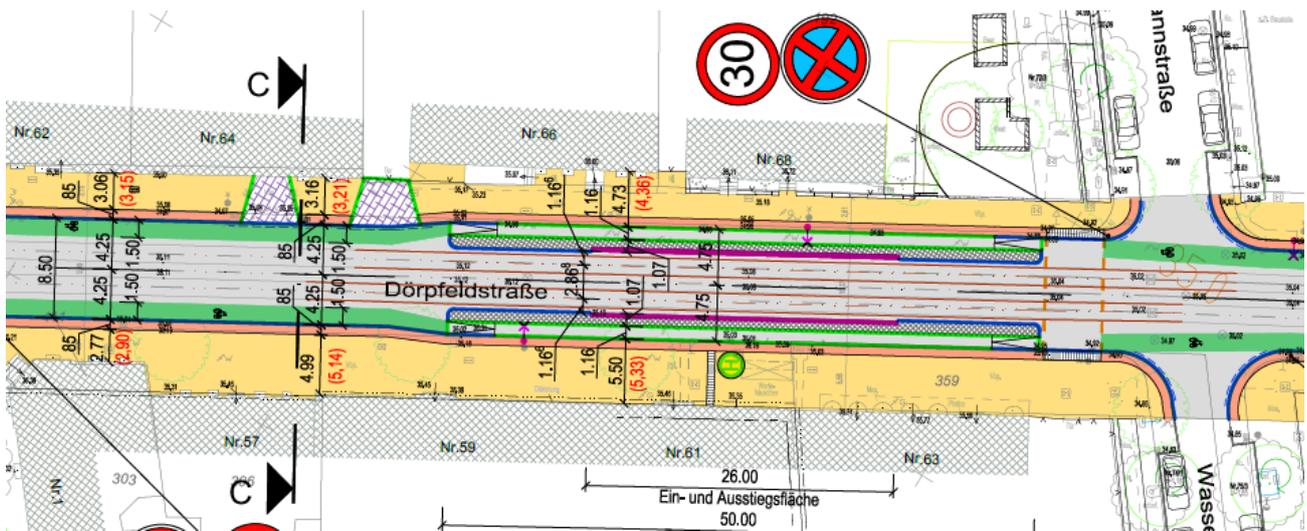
Lageplanausschnitt der empfohlenen Lösung an der Haltestelle Wassermannstraße und der breitesten Stelle westlich der Haltestelle, Quelle: Planungsbüro KÖPCONS GmbH
